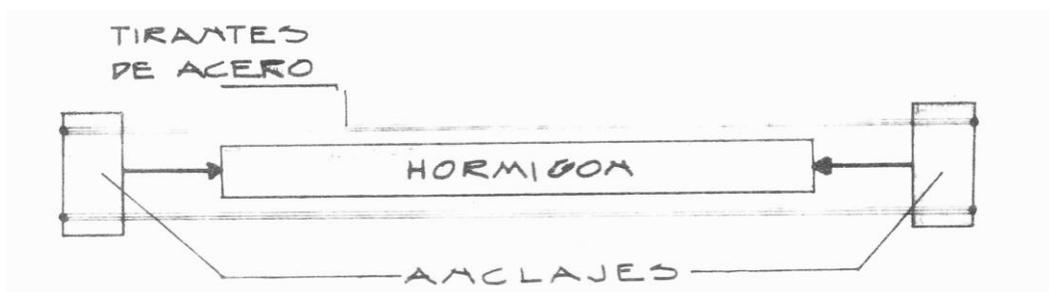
Figura de un elemento postensado sometido a compresión
